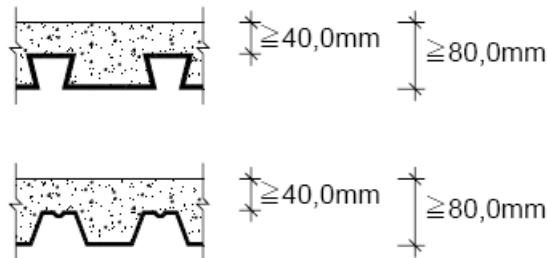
Espessura da laje. (“Lajes mistas,” n.d.)
